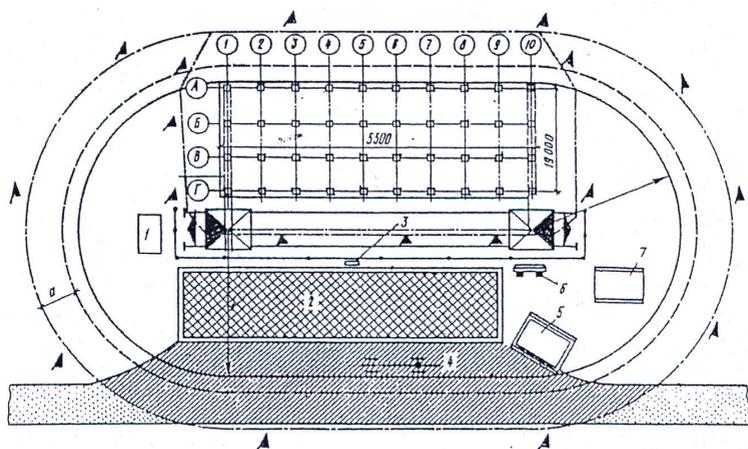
Обозначение зон башенных и рельсовых стреловых кранов: 1 — место контрольного груза; 2 — площадка для складирования; 3 — шкаф электропитания крана; 4 — площадка для разгрузки автотранспорта; 5 — площадка для приема раствора; 6 — стенд со схемами строповки грузов; 7 — место для хранения монтажной оснастки
